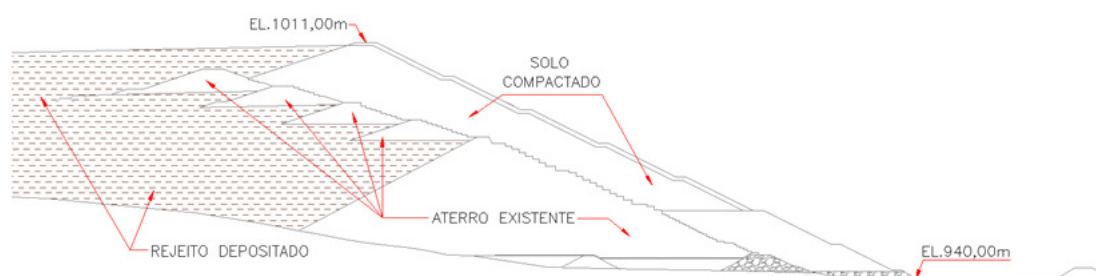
Seção típica do projeto de alteamento da Barragem Tico-Tico
